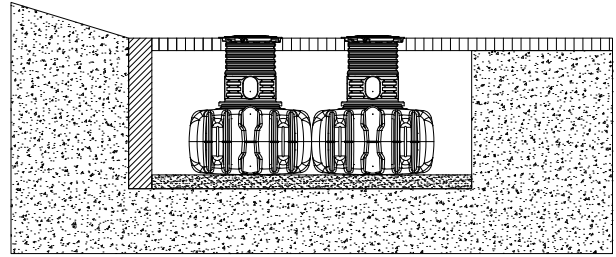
Installation sur terrain en pente – Exemple FLAT
